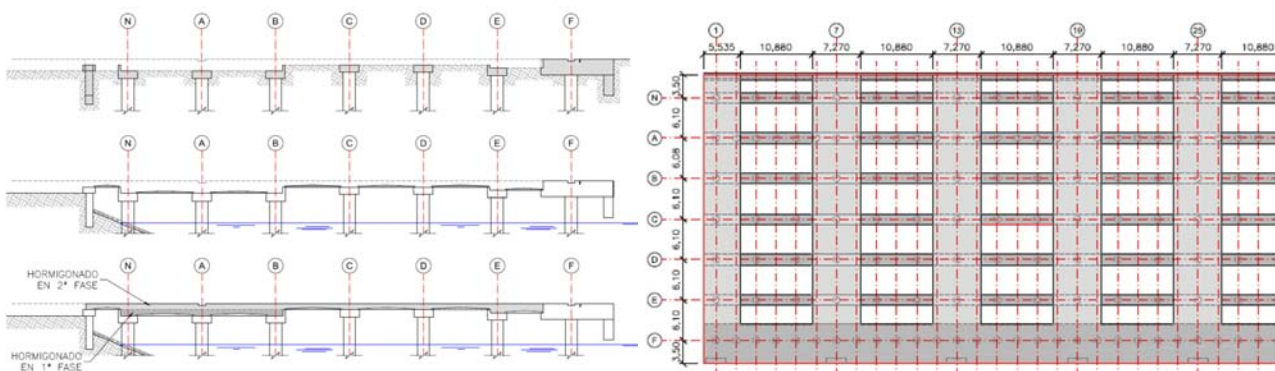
, 9b. Fases básicas del proceso constructivo, ejecución de pilotes y vigas, colocación de prelasas, hormigonado de losa en 2 fases. Planta de zona de fingers hormigonados sobre el terreno.
